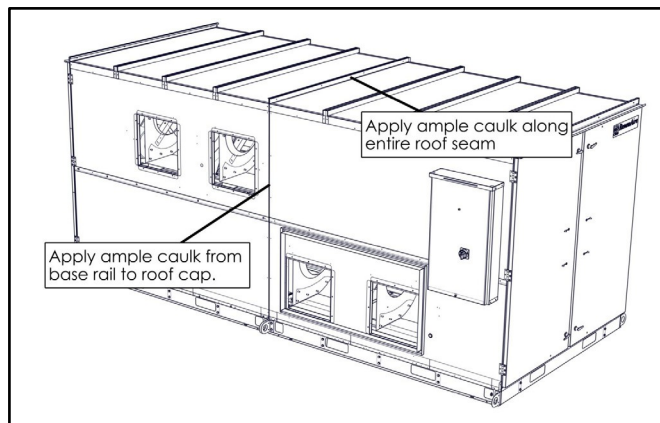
CALFEUTRAGE DES POUTRES DE TOIT
